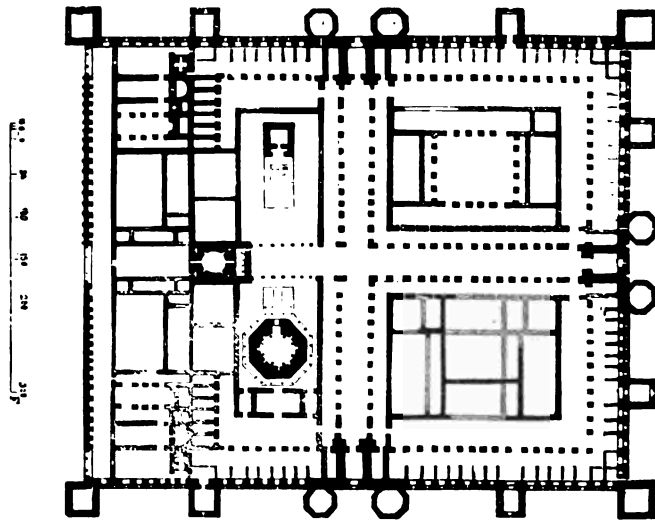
Palast des Diocletian zu Spalatro (Grundriß).
